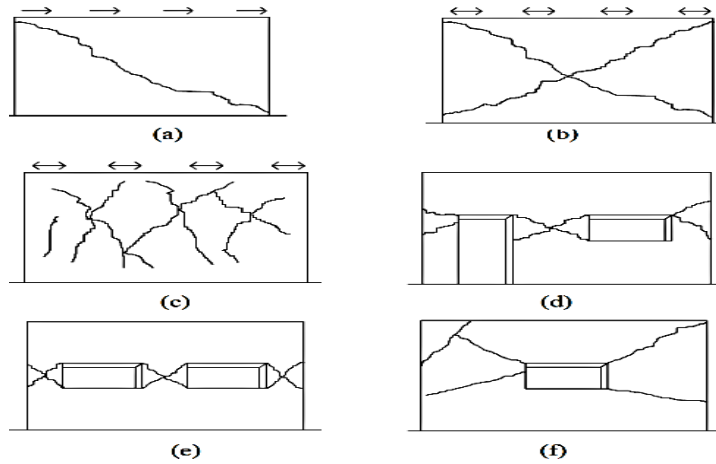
Grietas diagonales por fuerza cortante en el plano del muro.
